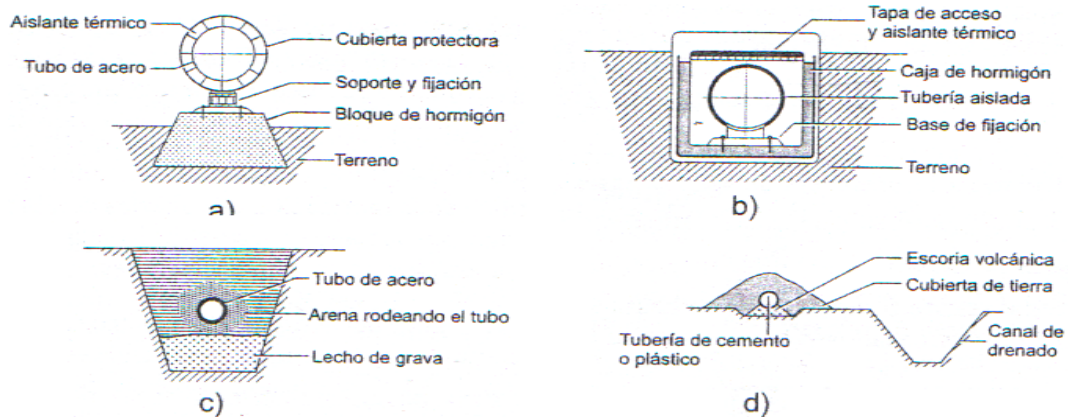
, ejemplo de instalación de tuberías para geotermia, a) Tubería al aire con aislamiento térmico y cubierta protectora metálica. b) Tubería aislada térmicamente y encajonada dentro de una zanja o canal de conducción de obra. c) Tubería aislada y enterrada. d) Tubería sobre una base de grava y cubierta protectora de tierra.
